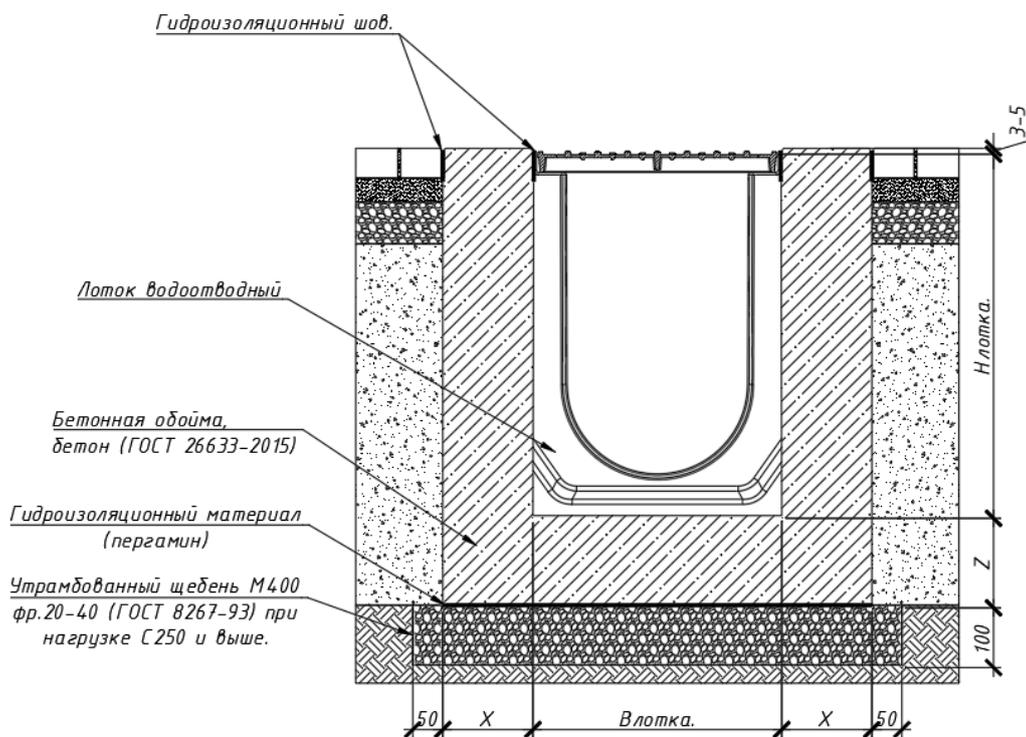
б – Устройство бетонной обоймы лотка с штучными элементами мощения для классов нагрузки от С250 до F900.
